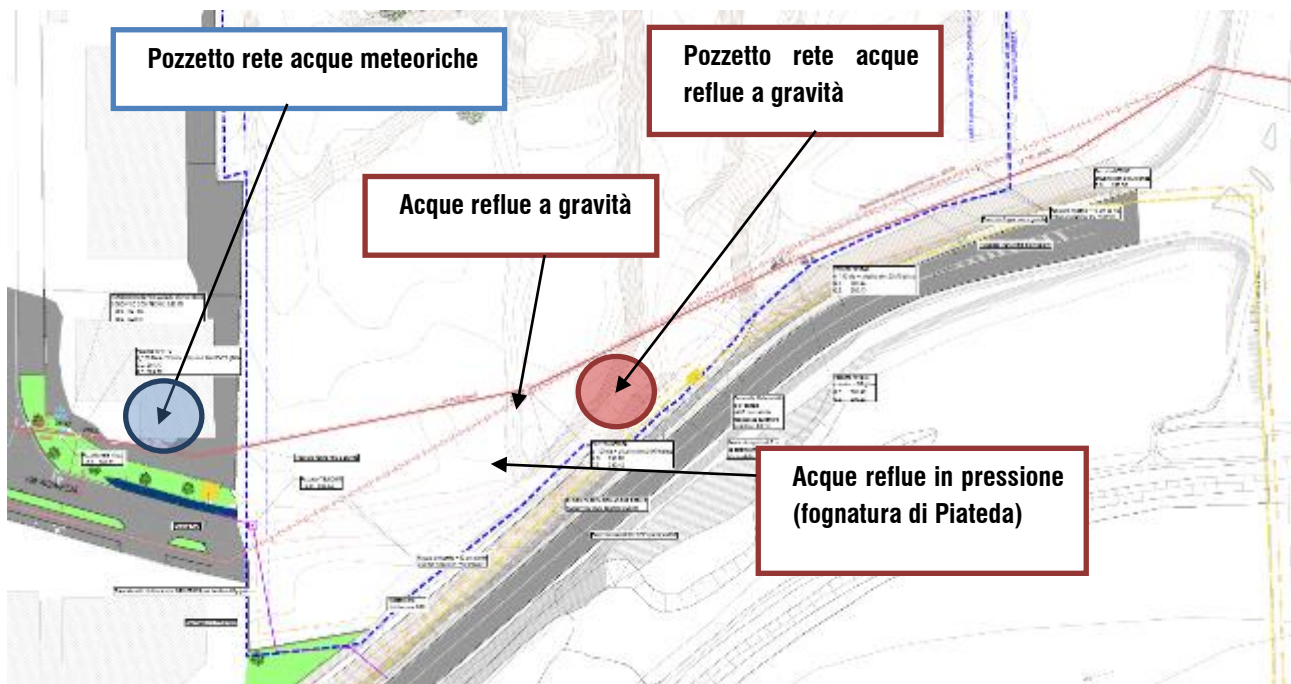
Estratto planimetria reti esistenti (elab. 00PC_OU_B001_20)
